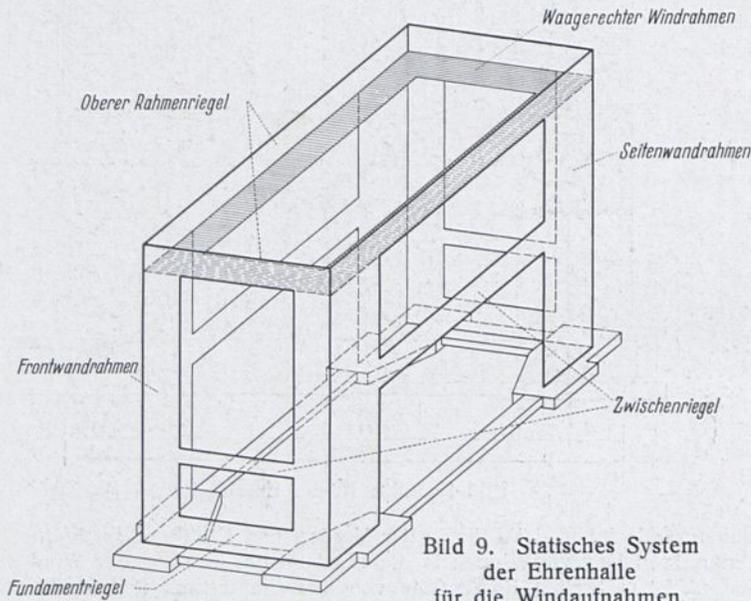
Statisches System der Ehrenhalle für die Windaufnahmen.
